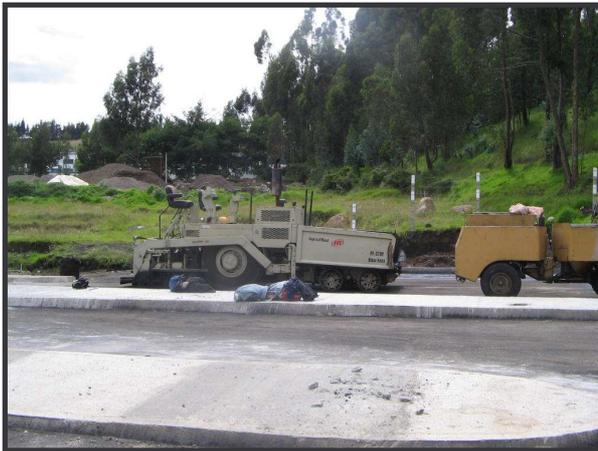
Pavimentación con asfalto en vías de CEDAP.
